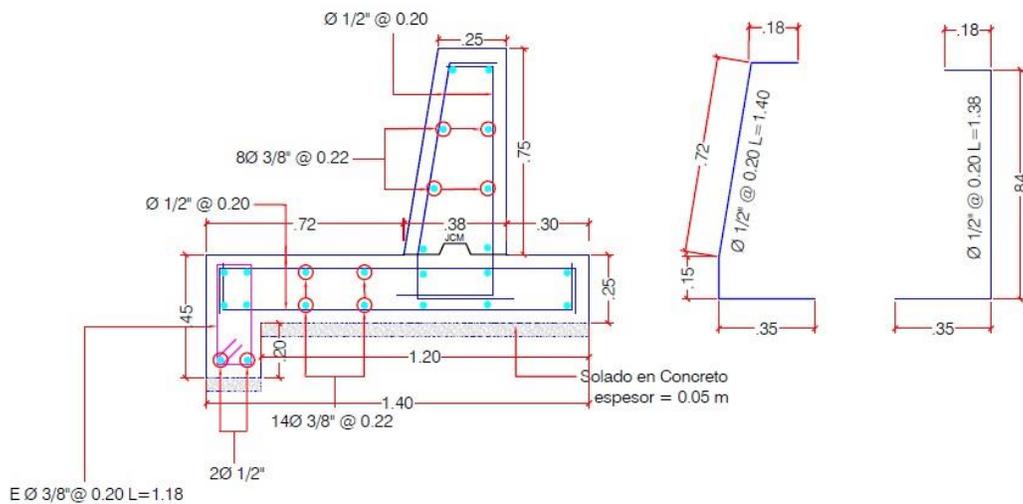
Detalle de Aceros, Muro de Contención Vía Interna. Fuente Diseño Ing. Pablo A. Ramírez B.
